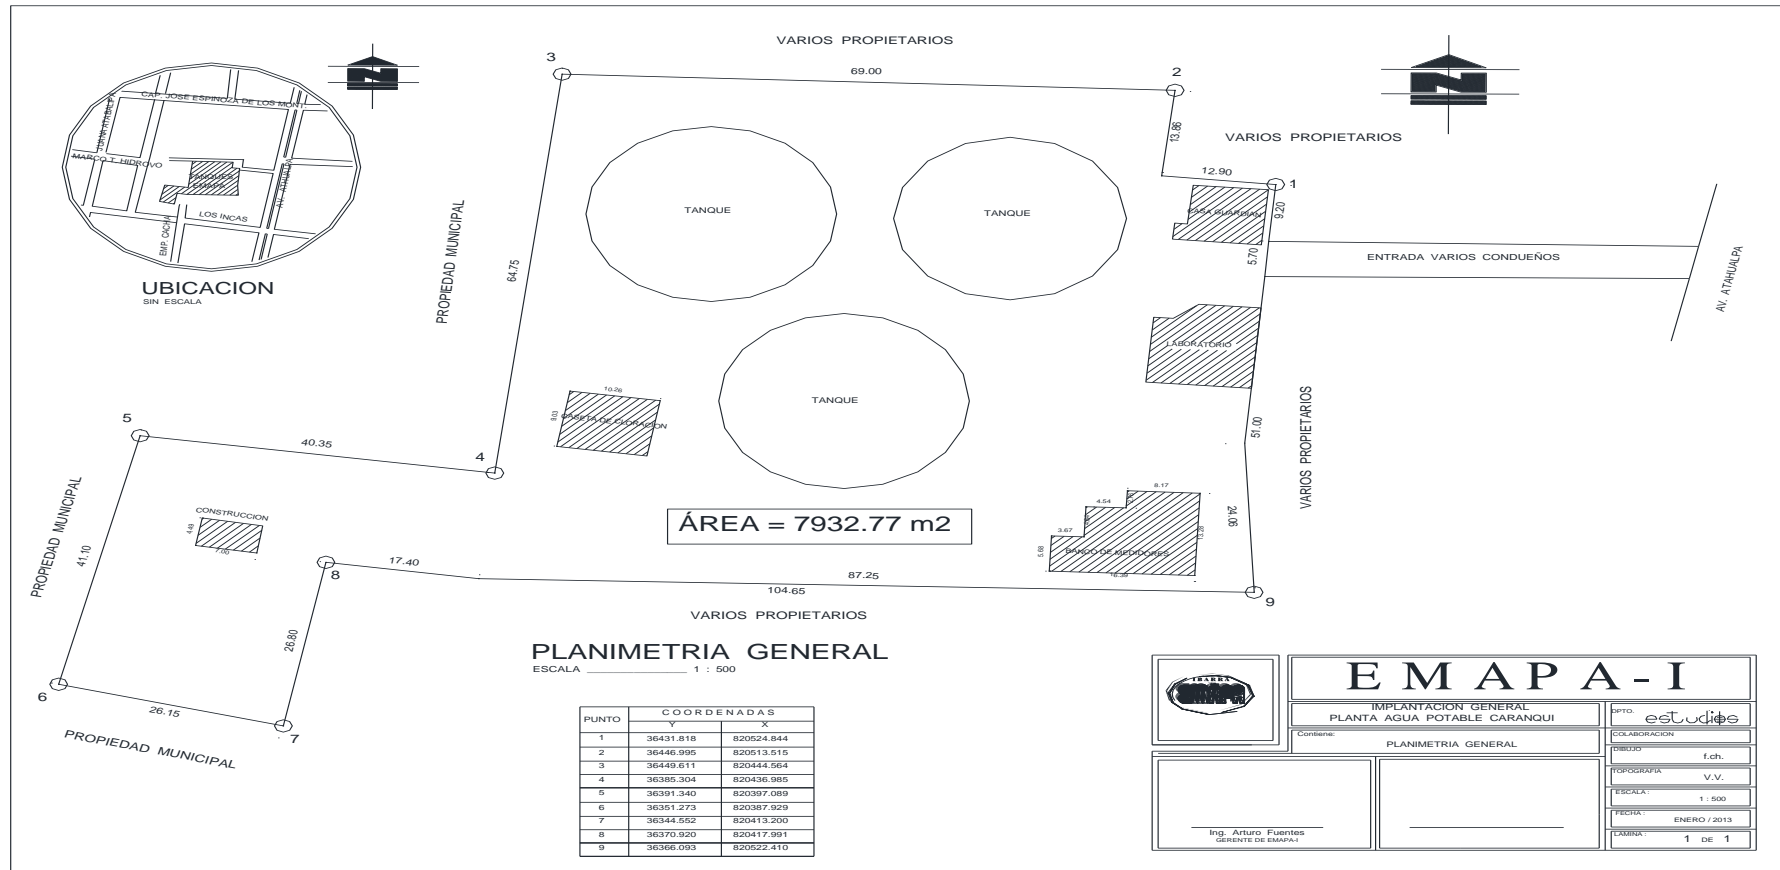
Plano del Laboratorio y Planta Caranqui
